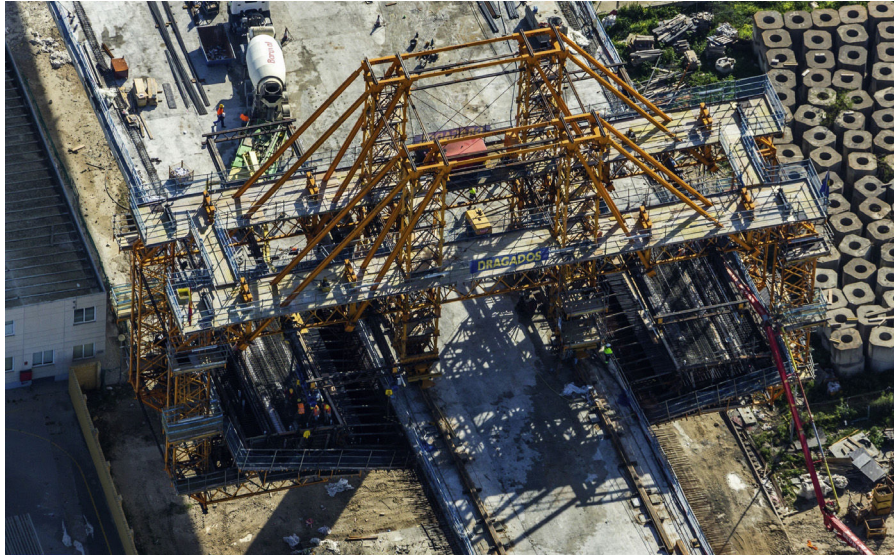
Tablero de hormigón. Carro de encofrado de segunda fase.
